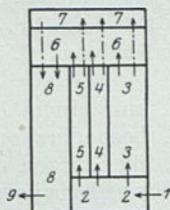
Kleinere Flachbauanlage mit zweistöckigem Verwaltungsquerbau vor den Längsschiffen. M. 1 : 1000.
